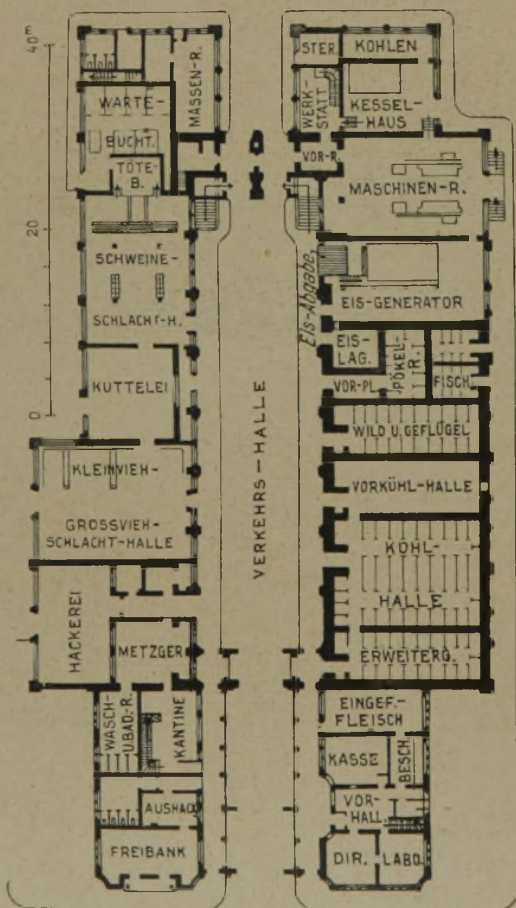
Grundriß des Betriebshauptgebäudes. (1 : 800.)
